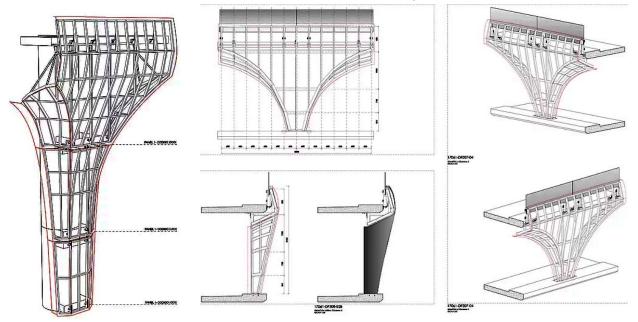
Detalles de subestructura para sujeción de paneles GRC
